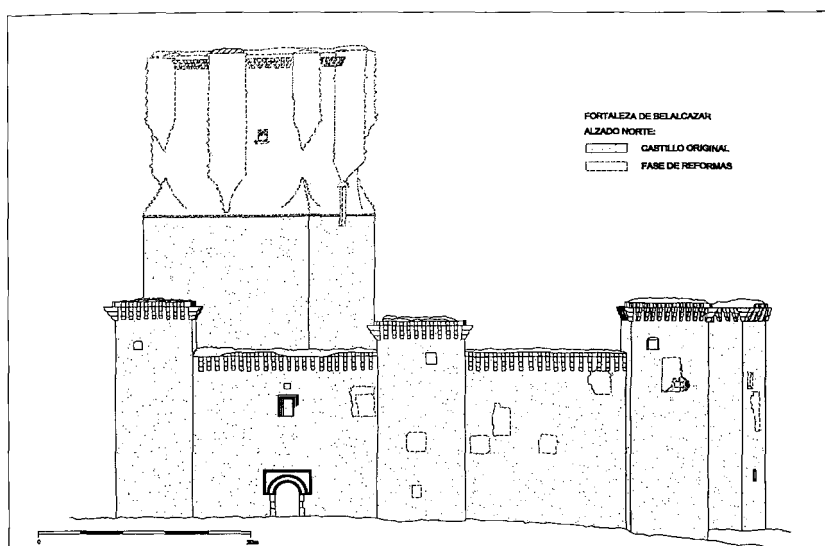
Fortaleza de Belcázar. Alzado norte.
